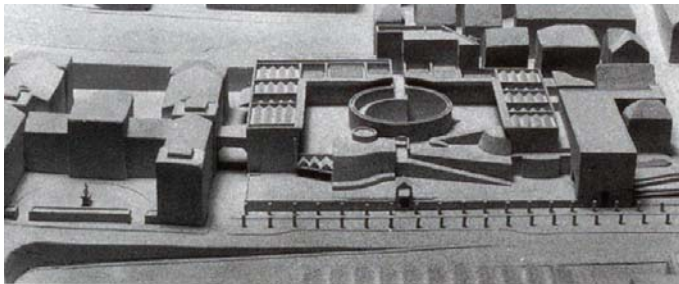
Modell + Lageplan Siegerprojekt *James Stirling and Partner 1977;
